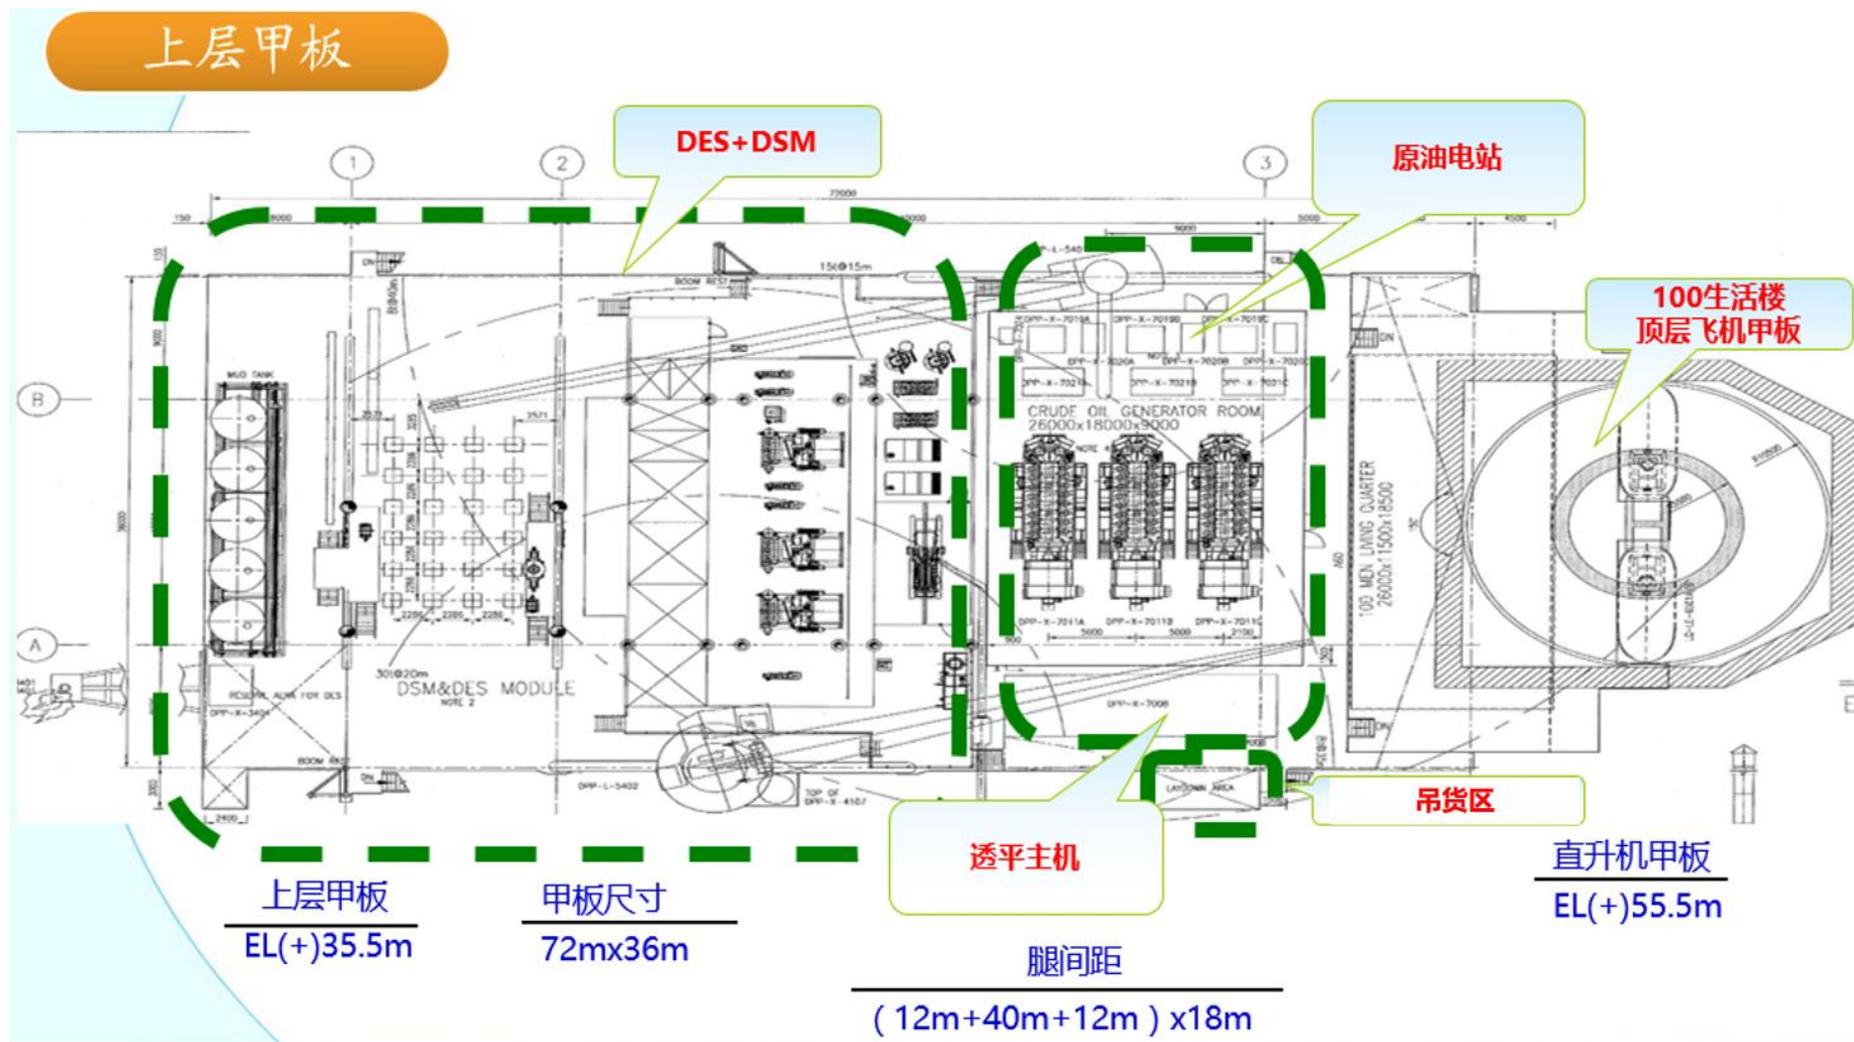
新建 LF14-4 DPP 平台上层甲板平面布置图
